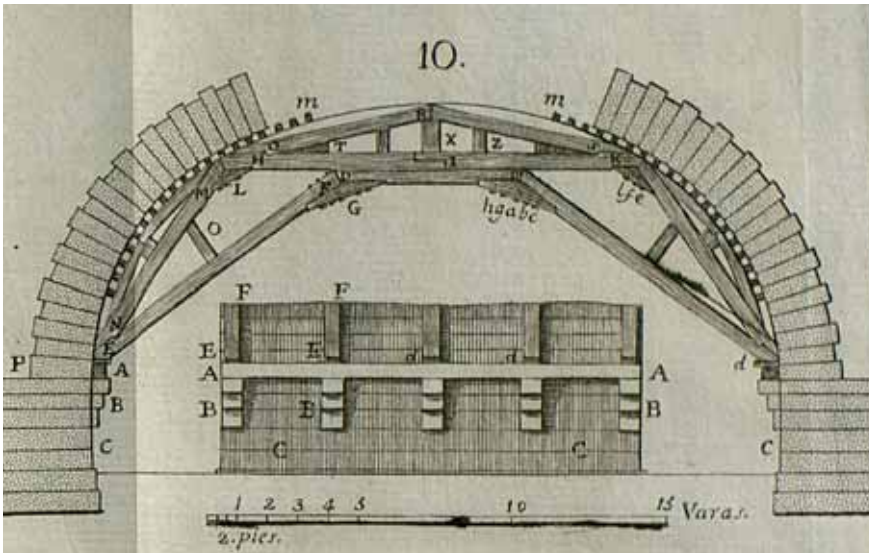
Detalle de hiladas de sillares donde se apoya la cimbra [4]
